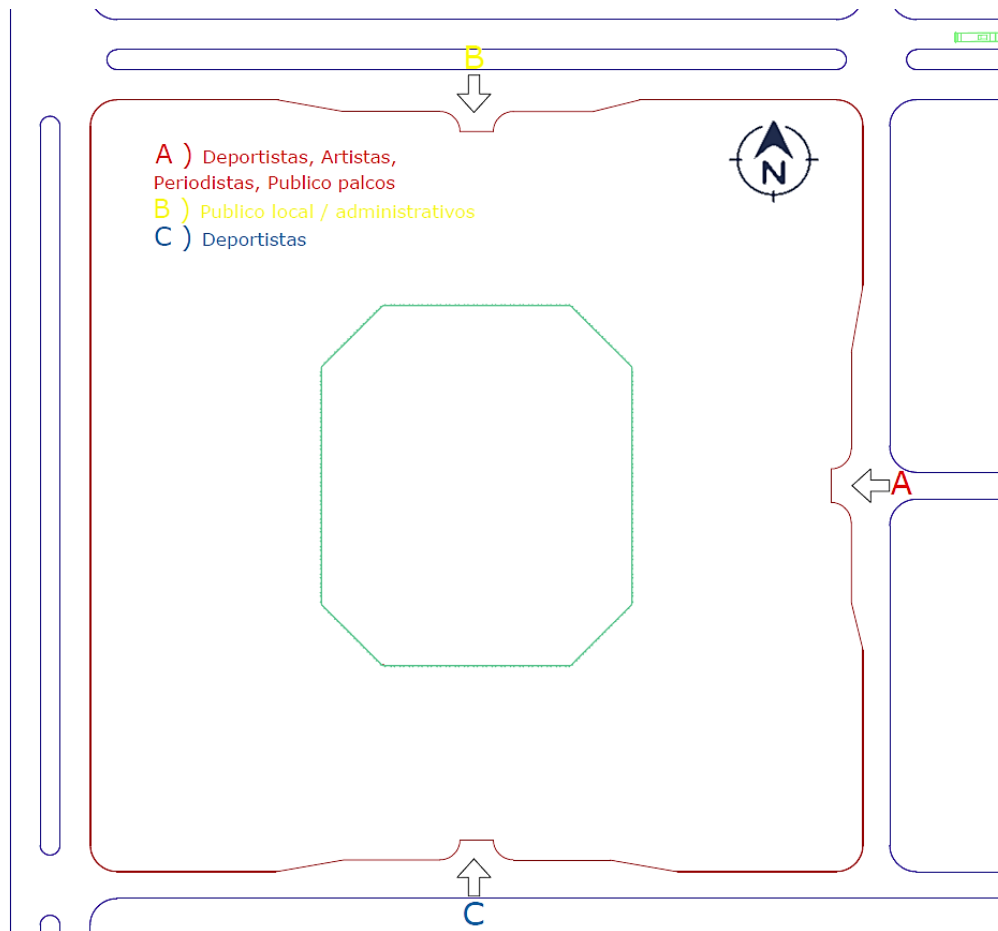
Vista en planta de los accesos vehiculares al predio. Fuente: elaboración propia.
